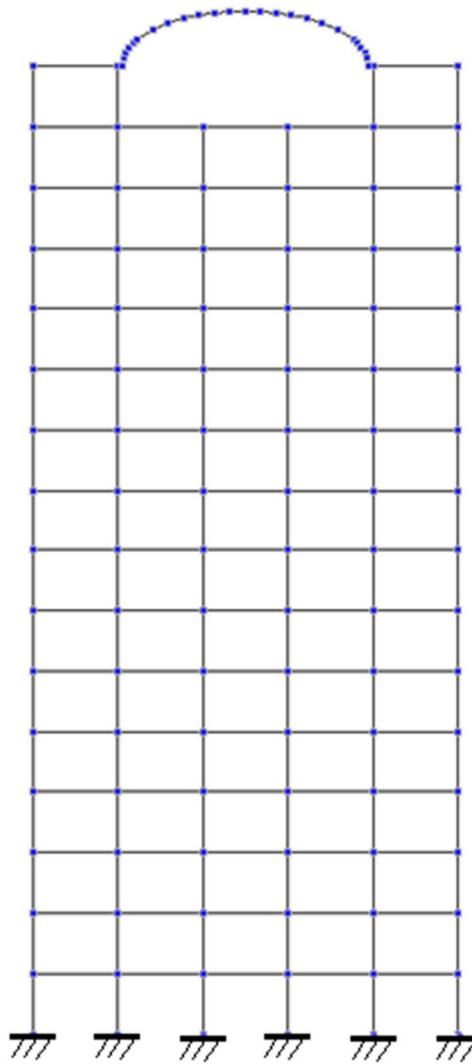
Розрахункова схема поперечної рами будівлі
